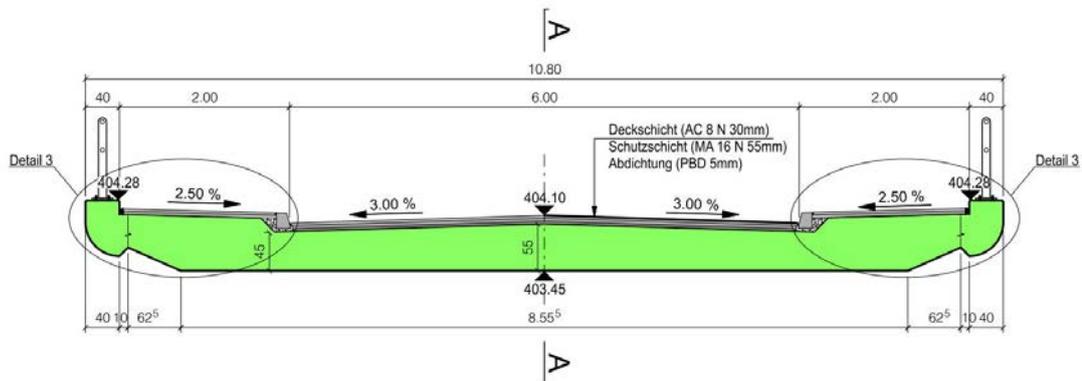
Querschnitt Brücke Walzenhauserstrasse, Littenbach
